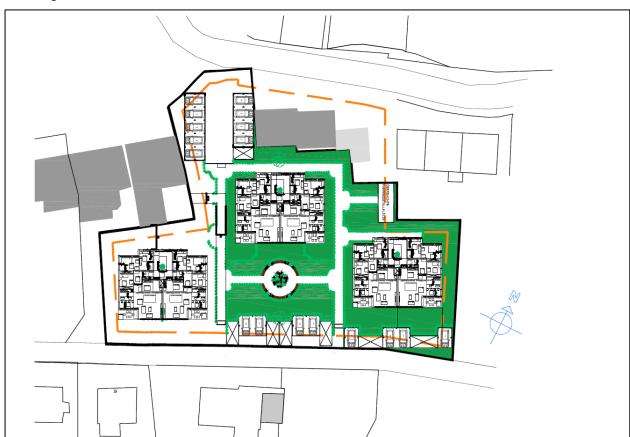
Weiss-Consult – Objektplanung – Lageplan Vorentwurf - ohne Maßstab
